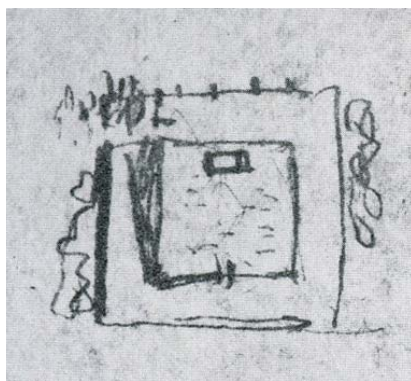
Dibujo girado 180° de la planta de la Iglesia de Tremblay. Fuente: FLC 32267
